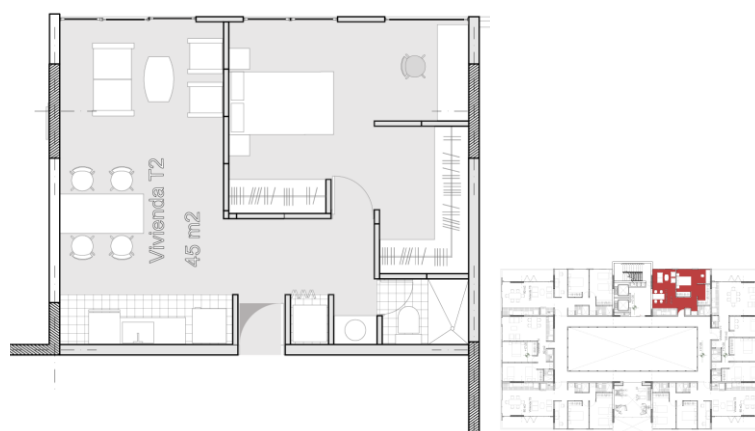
Planta Tipológica 2 (Jordan Baldassari, 2018)
